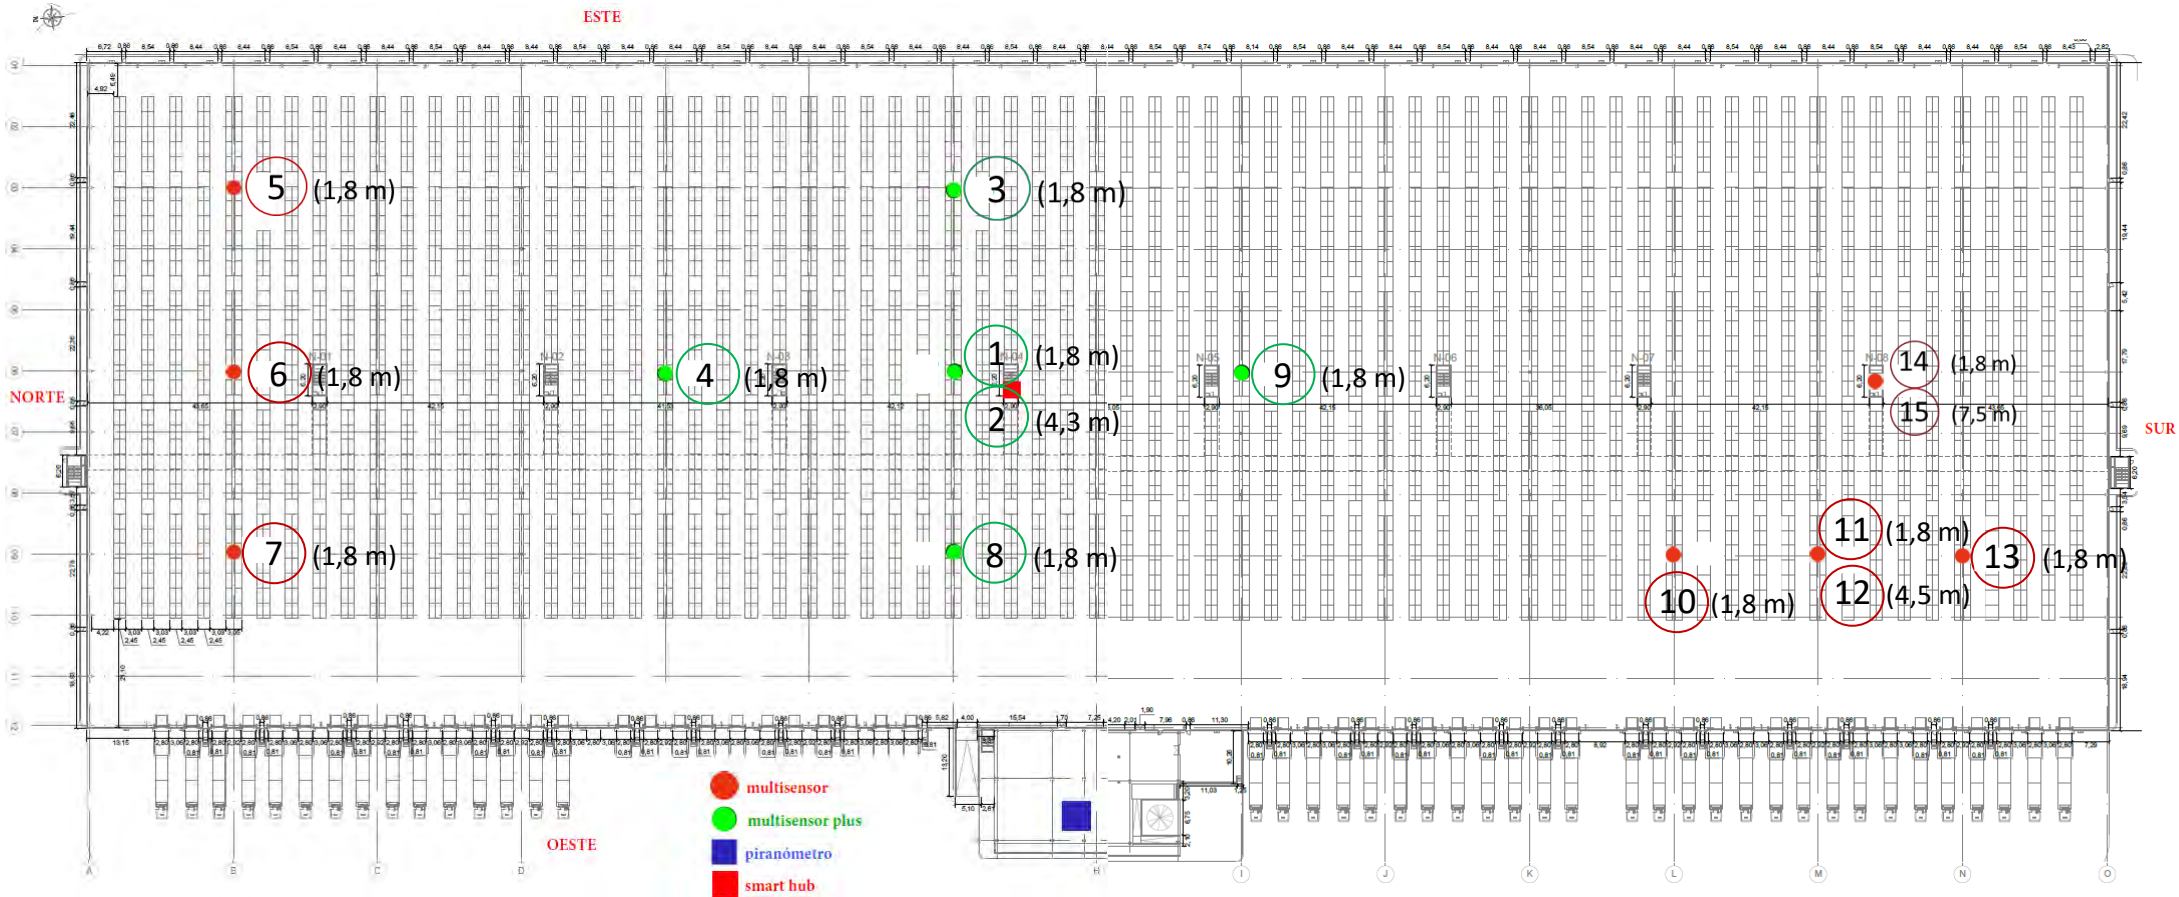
Vista en planta de la nave Marchamalo 2B, con la localización de los equipos de medida instalados
